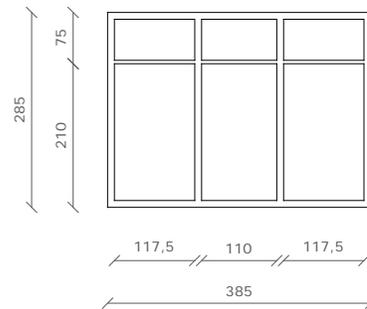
CON HOJA ABATIBLE DE EJE HORIZONTAL, PRACTICABLE HACIA AFUERA EN SU EXTREMO SUPERIOR.
